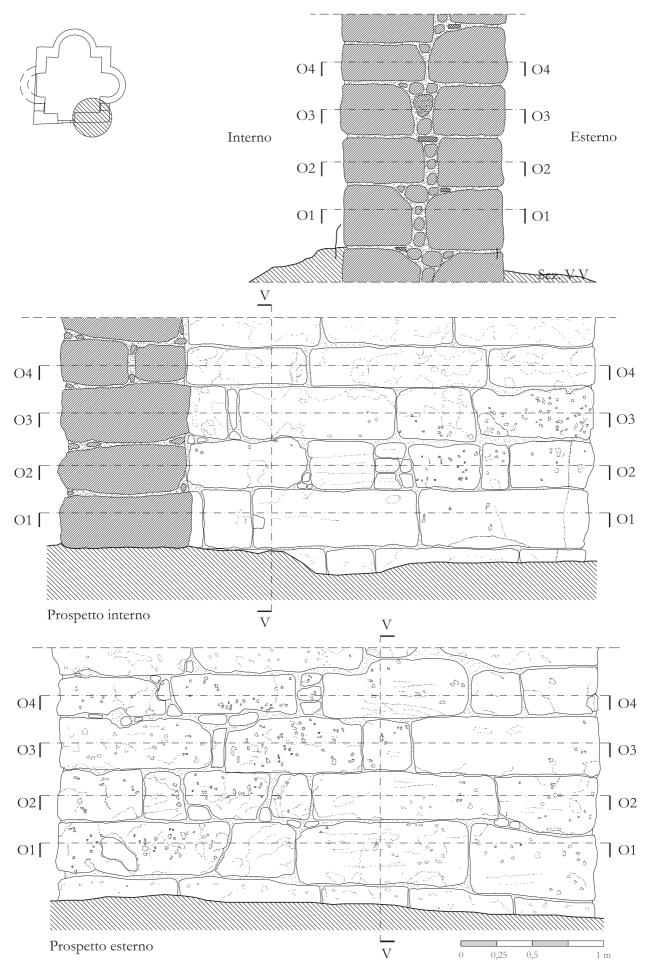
Dettaglio dell'apparecchiatura muraria in sezione verticale e in prospetto.
